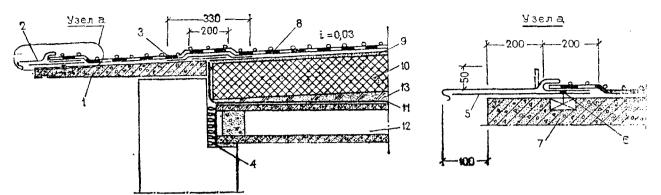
Кояструкция невентилируемого бесчердачного совмещенного покрытия с наружным отводом воды
